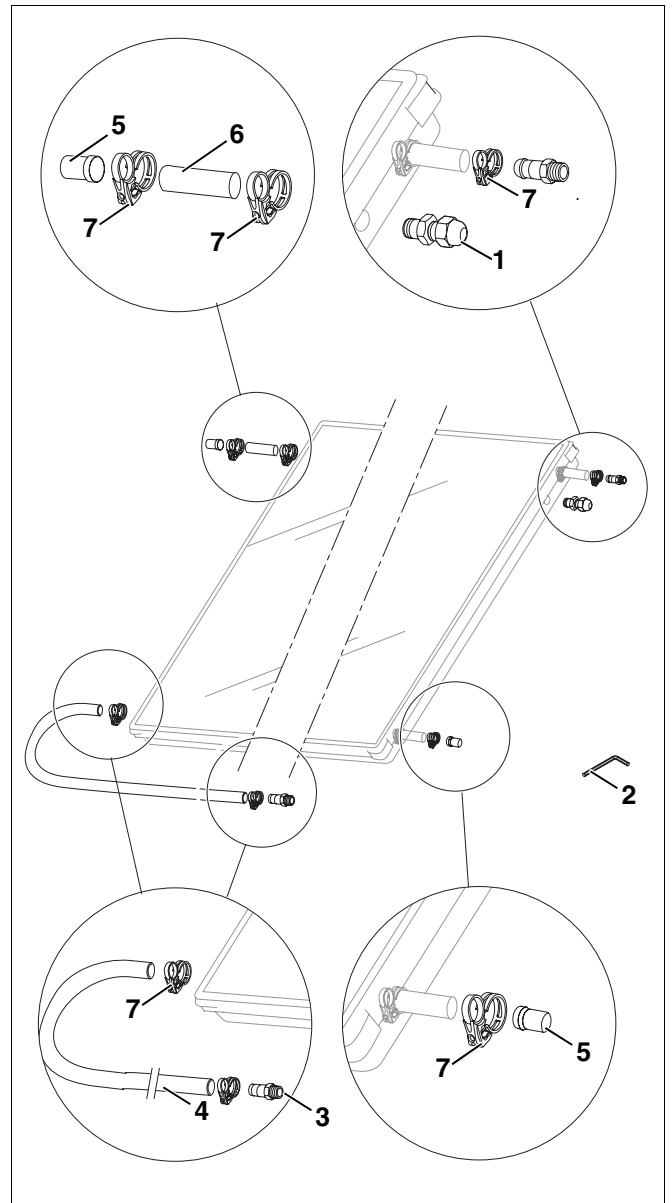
Juego de montaje básico para tuberías por fila de colectores
